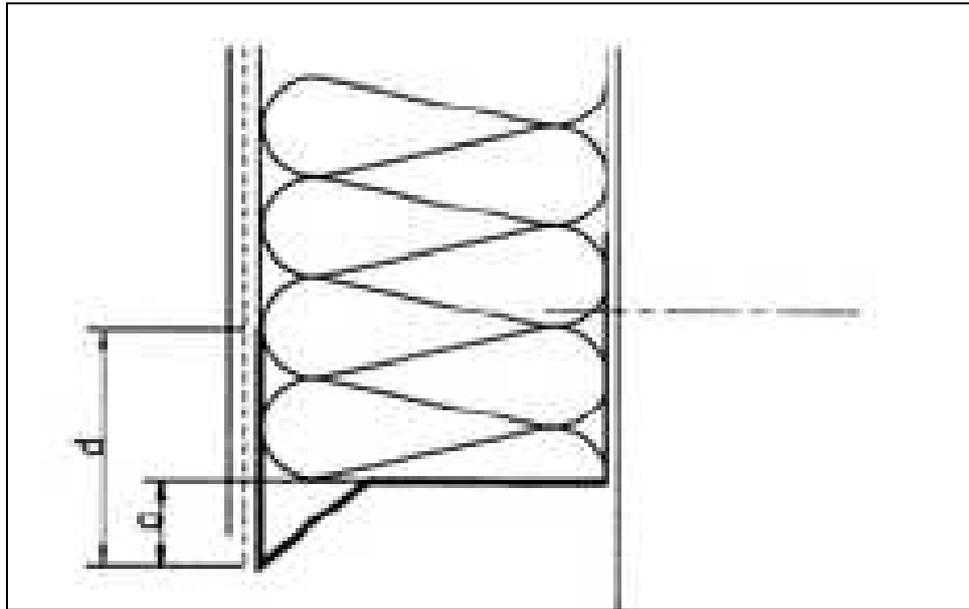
Placa que se utiliza a lo largo de todo el muro en el encuentro con el piso. Puede ser de PVC o metálico y se fija a muro.
